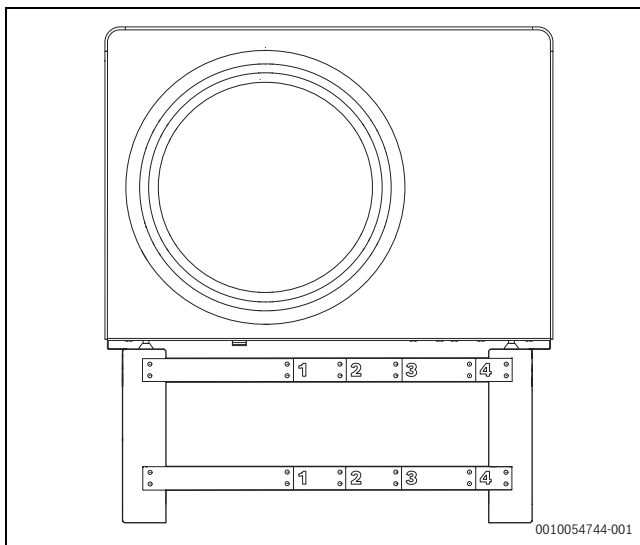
Příklad instalace: Prefabrikovaný základ v zemi
